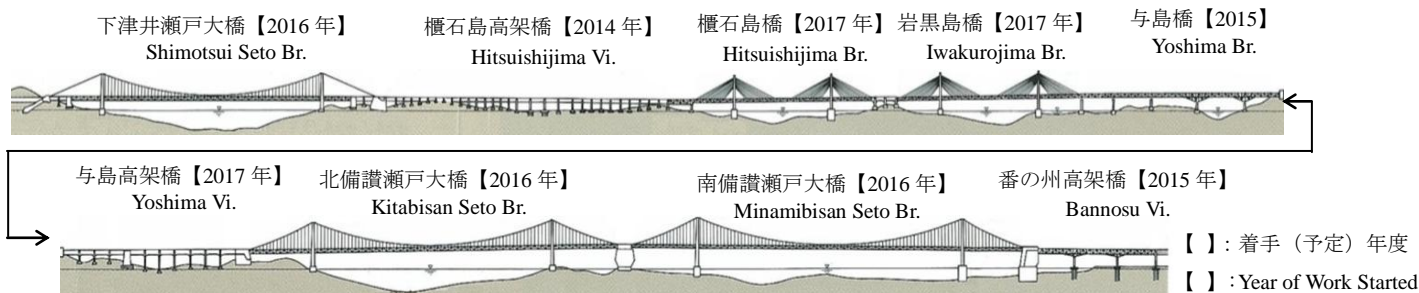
瀬戸大橋 Fig.-1 Seto-Ohashi Bridges
